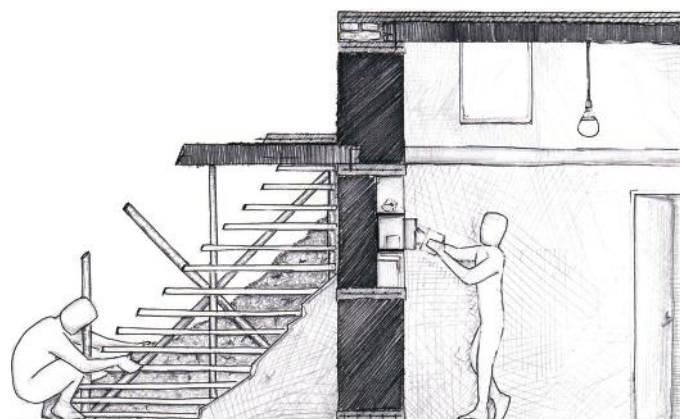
Detall constructiu. S'observa la connexió entre la tàpia i els murs de bareque, disposats perpendicularment.
